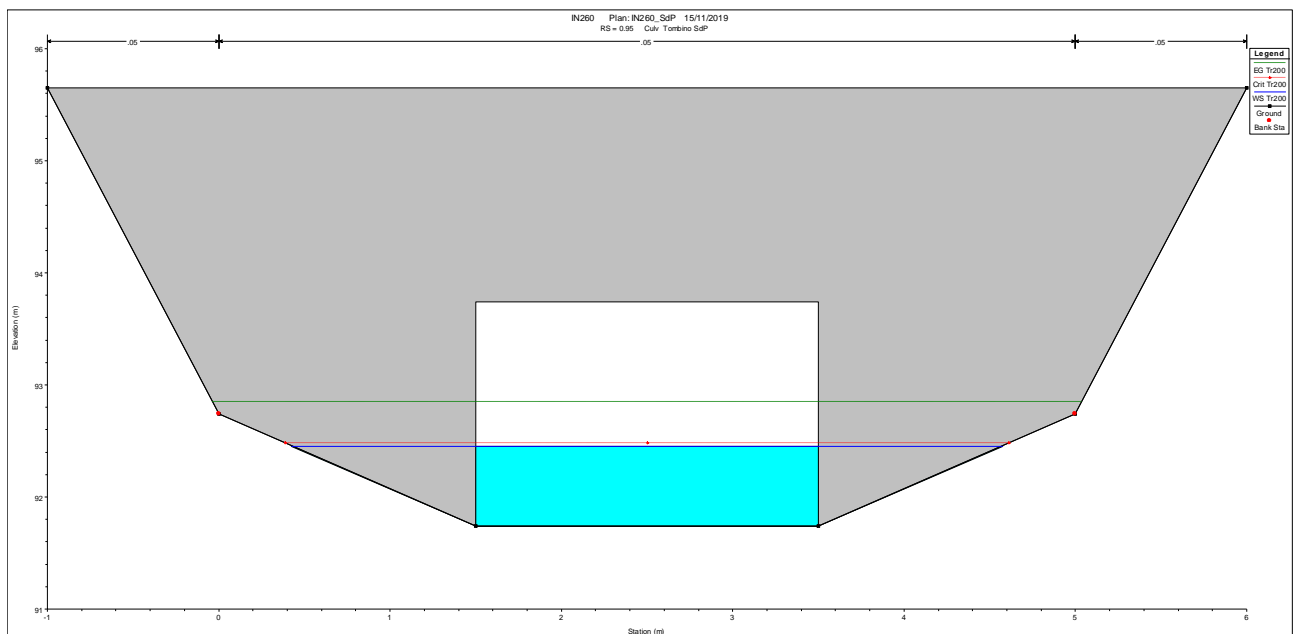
Sezione valle manufatto – stato di progetto interferenza IN260.
